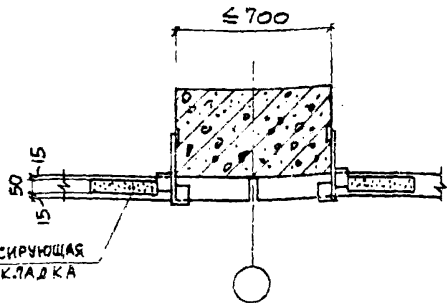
В поперечных перегородках у средних колонн здания с высотой сечения колонны ≤ 700 и у факеловых колонн
